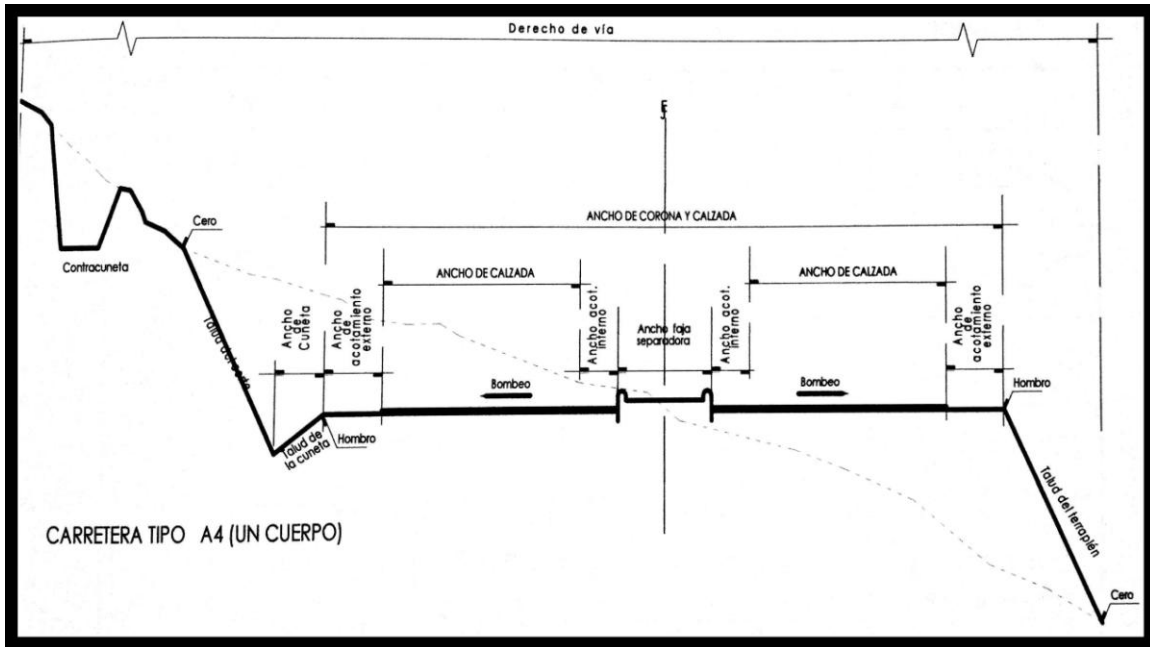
Sección transversal en tangente del alineamiento horizontal para carreteras tipo A4.
